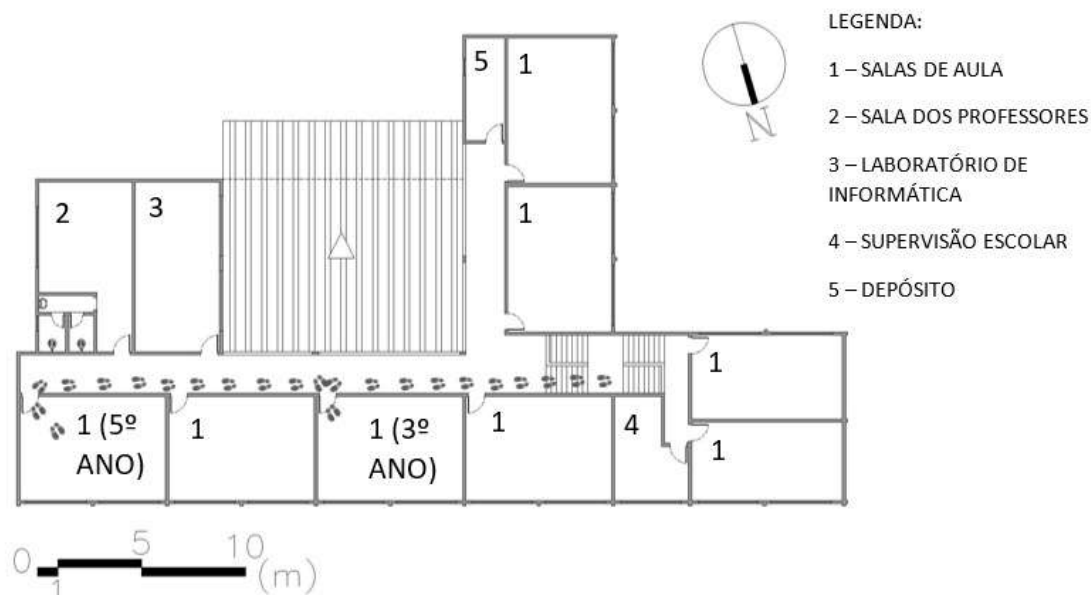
Percurso do Walkthrough no segundo pavimento -
